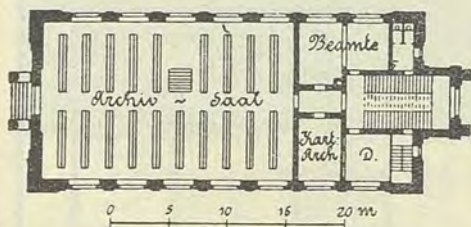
a, b. — Archivio di Stato di Weimar (arch. Streichan, Schlegel).
